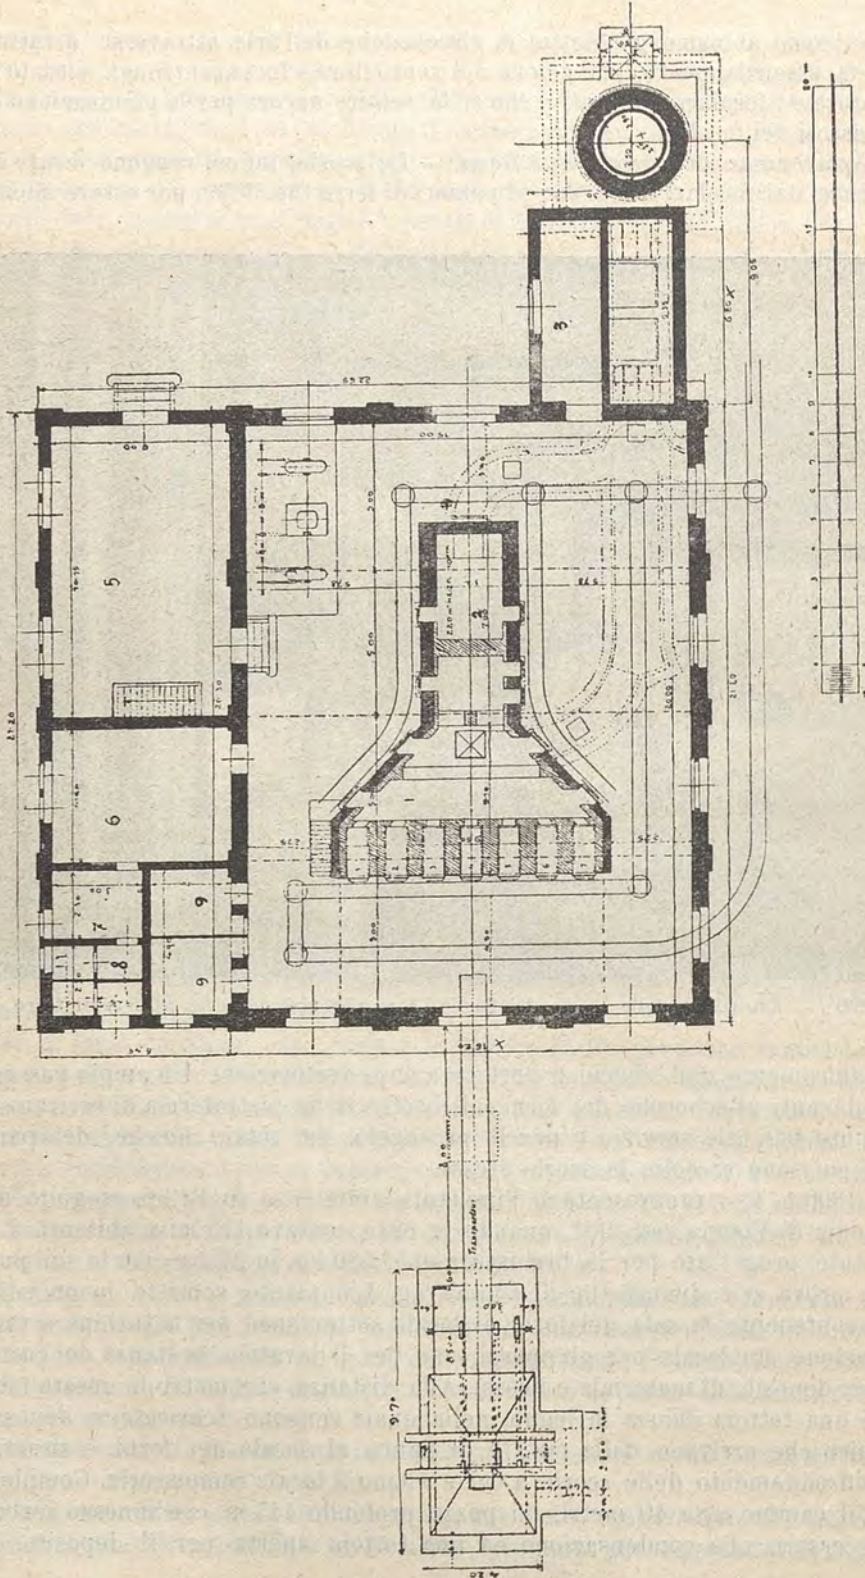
a, b, c. — Impianto per incinerimento delle spazzature della città di Brunn.
